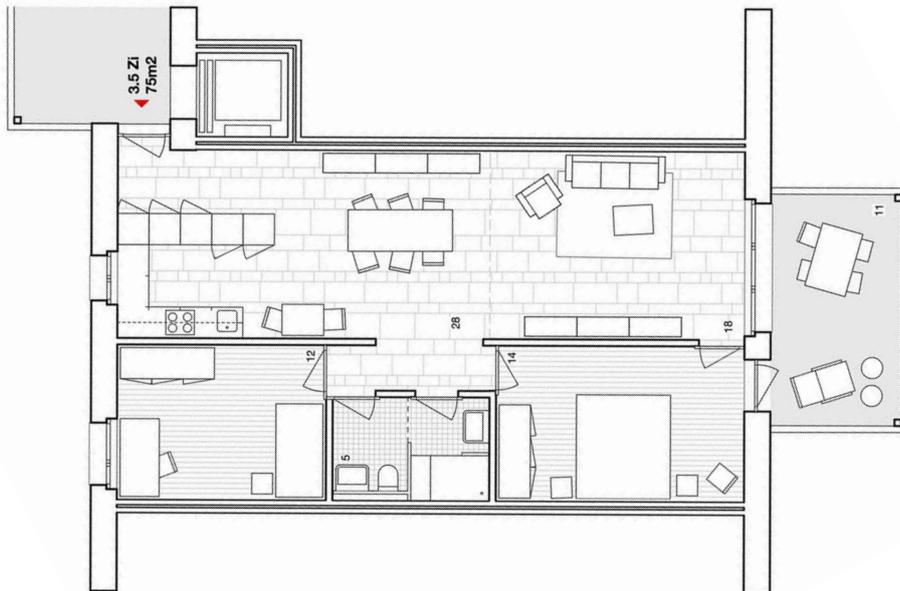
Wohnungsgrundriss 3.5 Zimmer - Whg.
